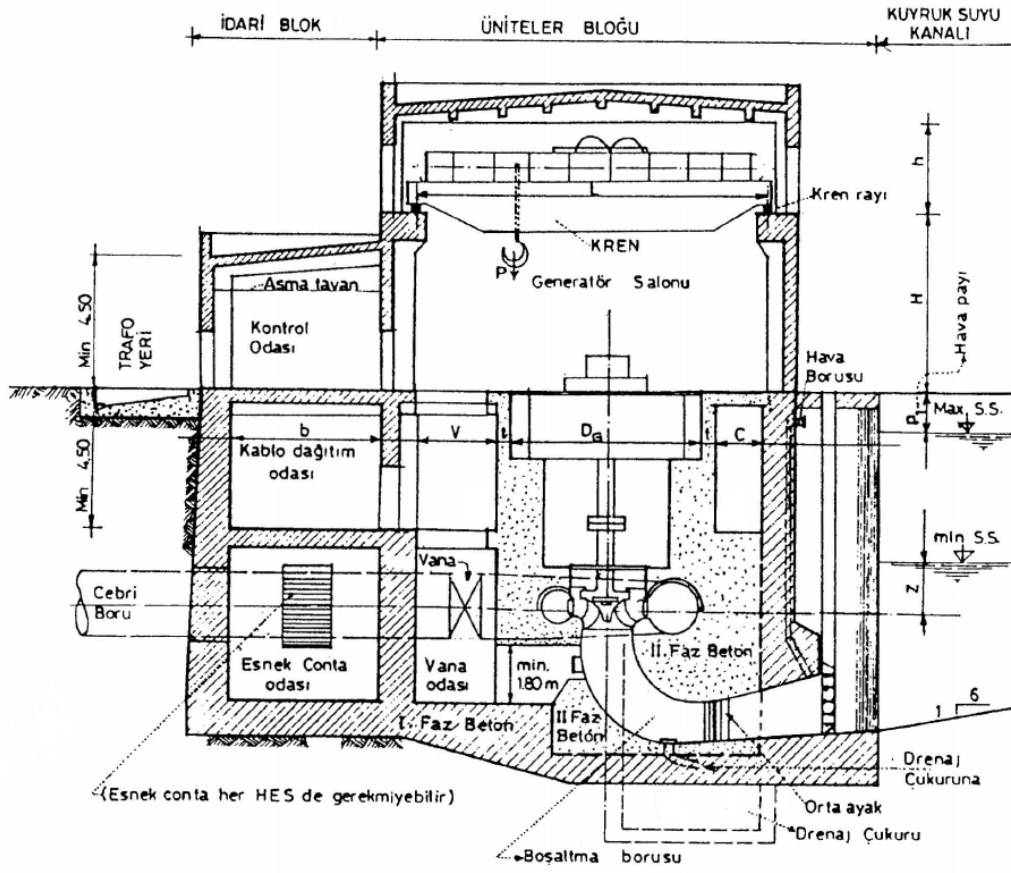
Vana odası kotu dizayn planı (Başesme, 2003).
